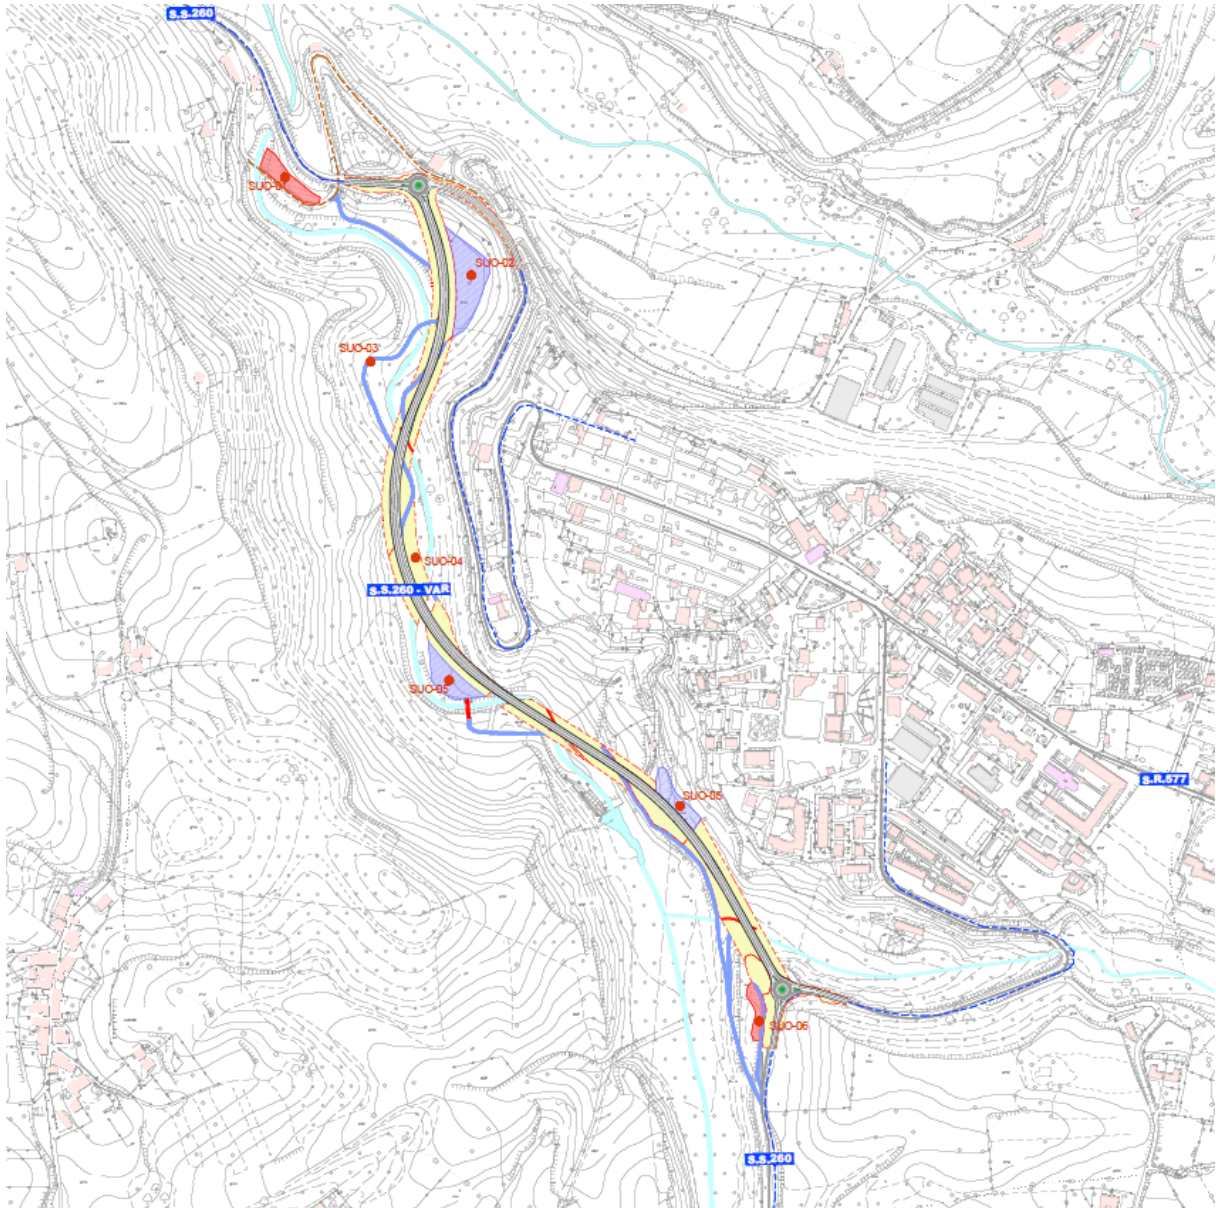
Planimetria punti di monitoraggio componente Suolo
